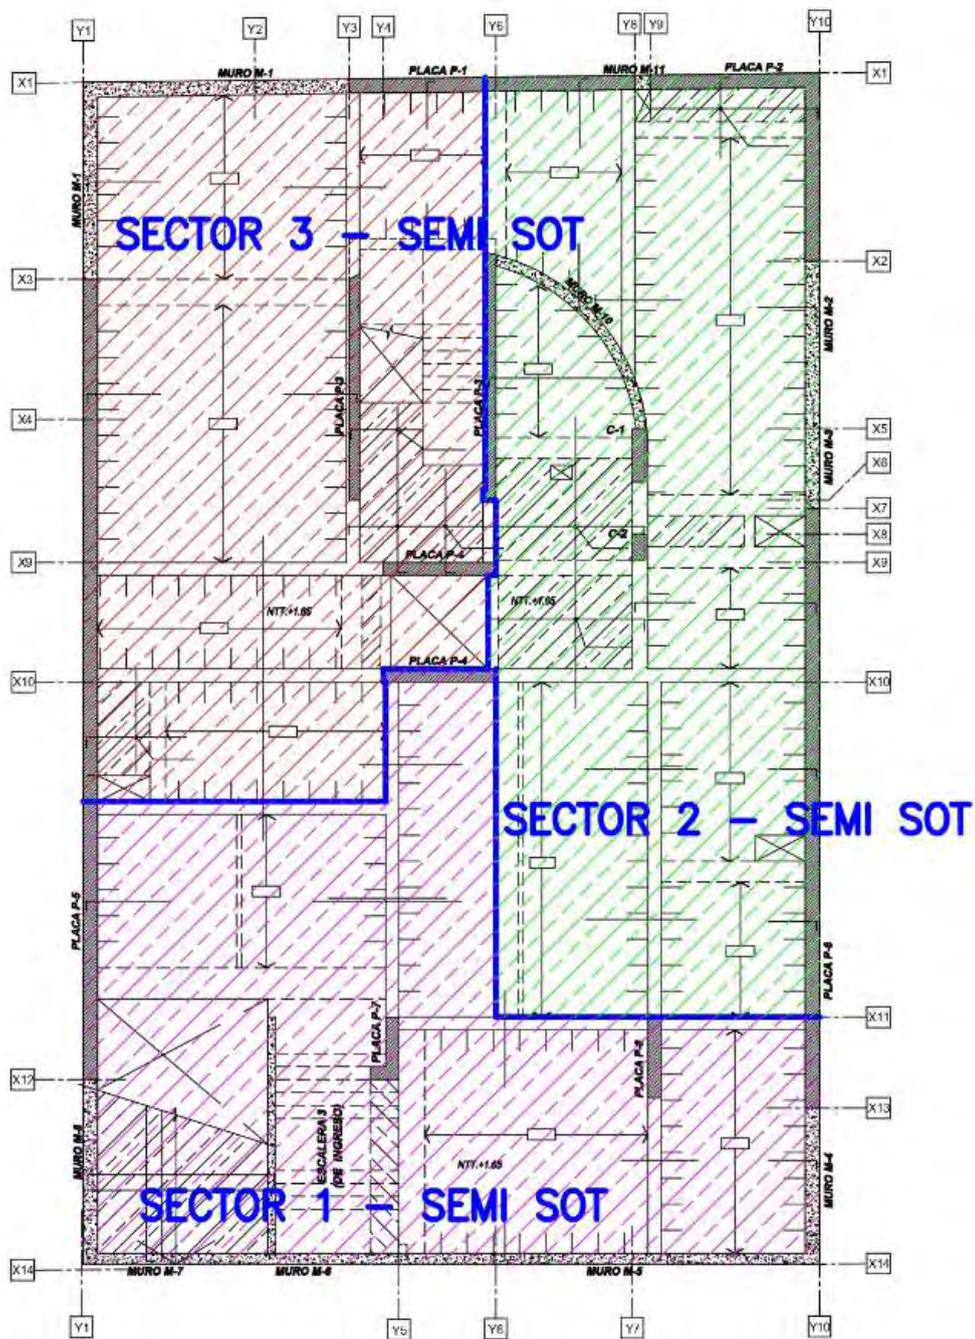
Sectorización del encofrado del semisótano para la construcción del proyecto.
